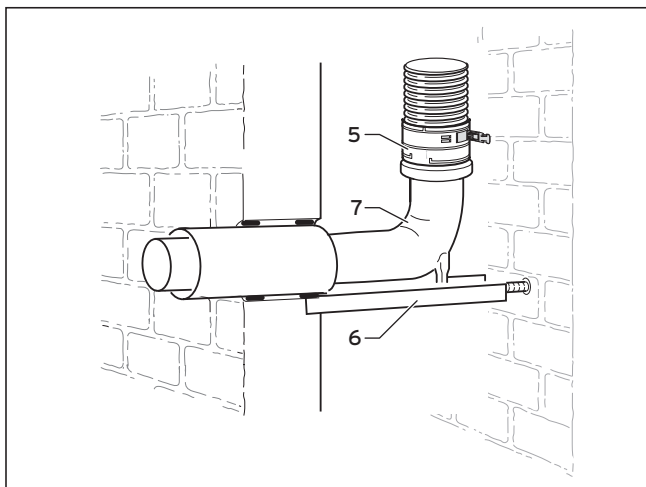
Raccord concentrique sur le conduit des fumées flexible
